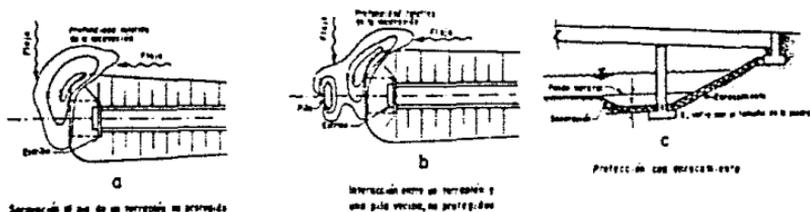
PROTECCION DEL TERRAPLEN DE ACCESO Y DE UNA DE LAS PILAS DE UN PUENTE MEDIANTE UN ENROCAMIENTO (Ref. 7).
